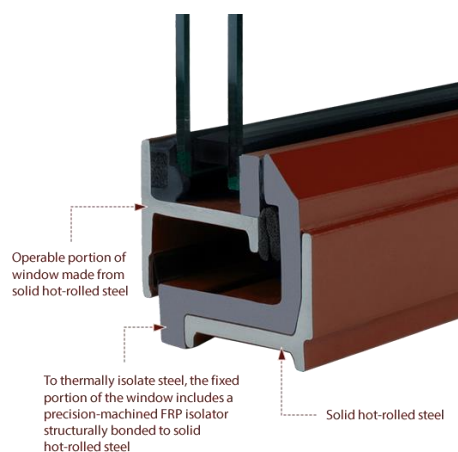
Pormenor da solução construtiva do caixilho de uma janela, com aplicação de adesivos na colagem dos elementos que a integram [15].
